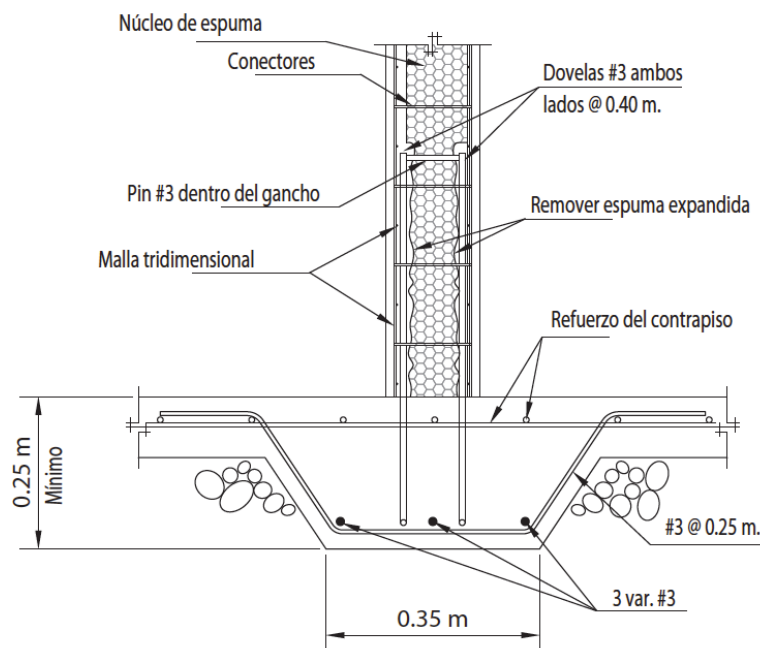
Detalle de fundación para paredes tipo emparedado según CSCR-10
